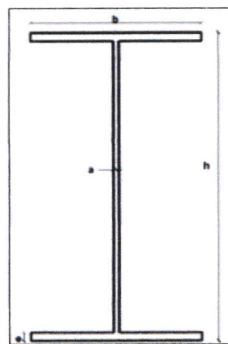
poutre IPN 400 ; source auteurs 2018.
